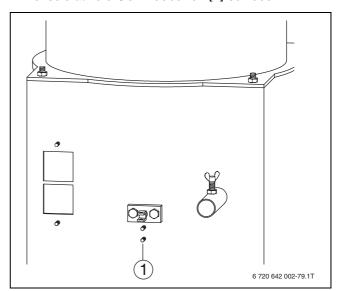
Position des Brennerreinigungsmotors am Heizkessel
